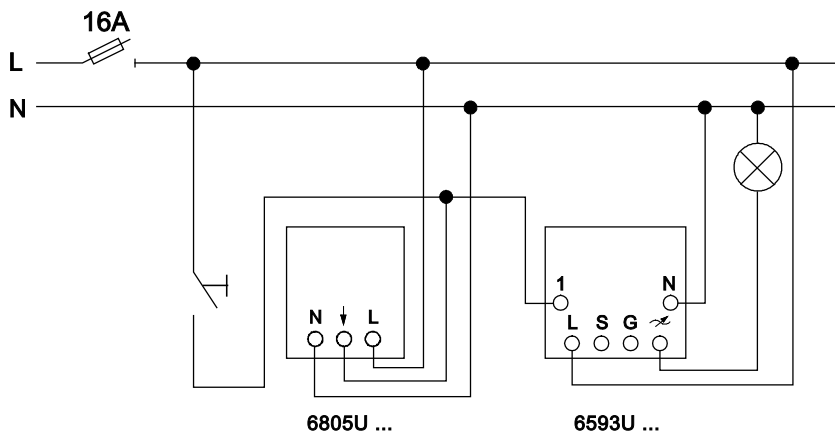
Светорегулятор 6593U ... со вспомогательным устройством 6805U ... с контрольным реле Busch-Wächter® и вспомогательным устройством с замыкающим контактом
